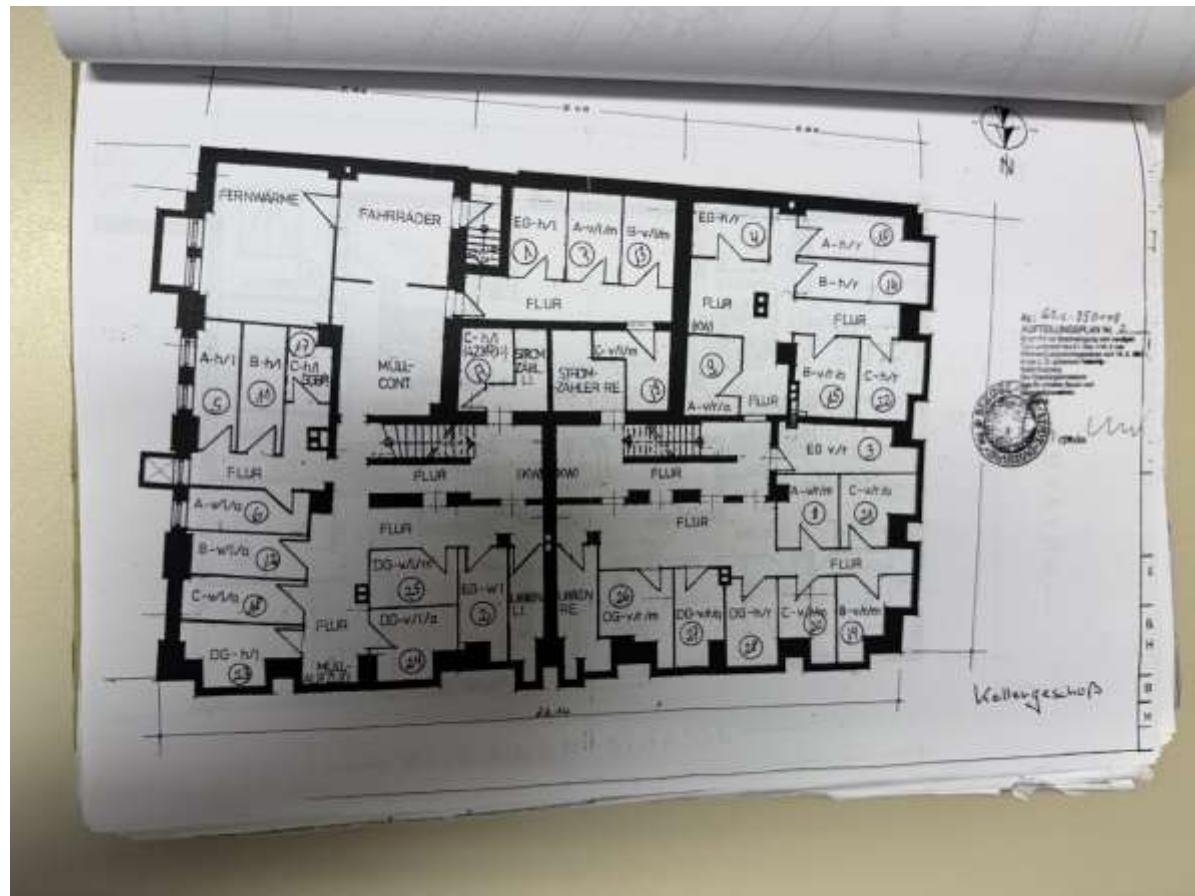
SE Nr. 16 Kellergeschoß Quelle: Grundakte AG Duisburg - Teilungserklärung
